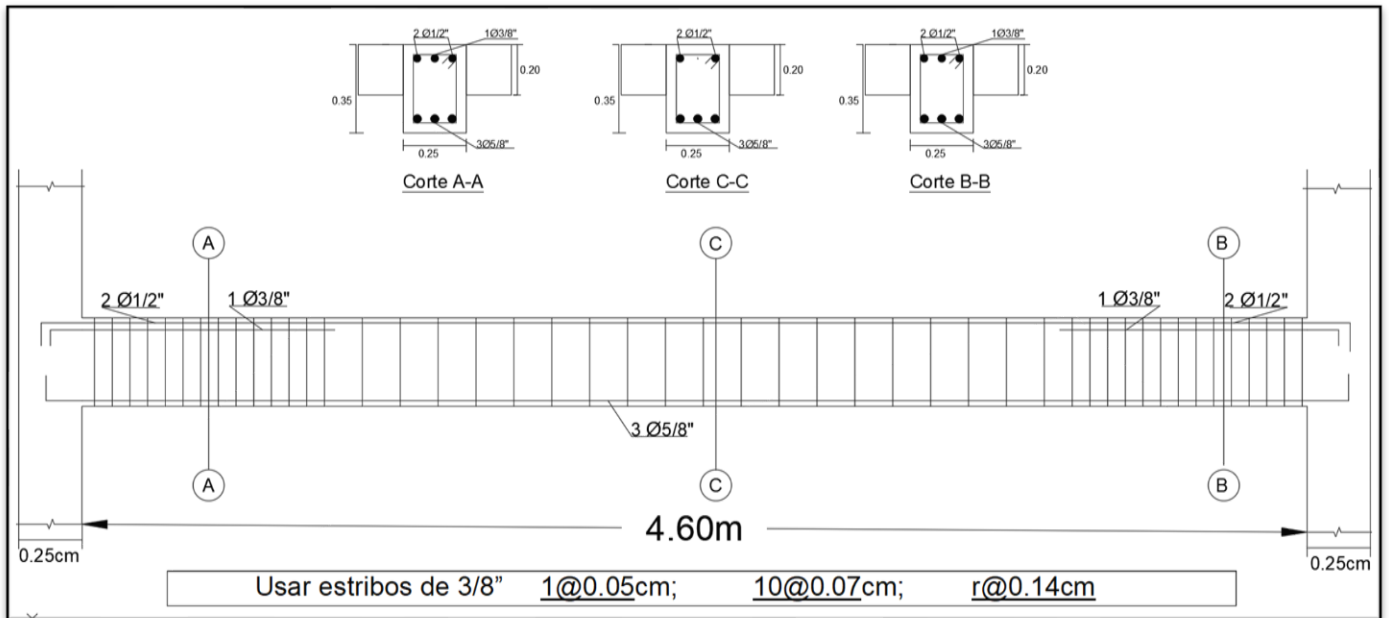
Detalles de la distribución de aceros de la viga más esforzada en el primer piso
